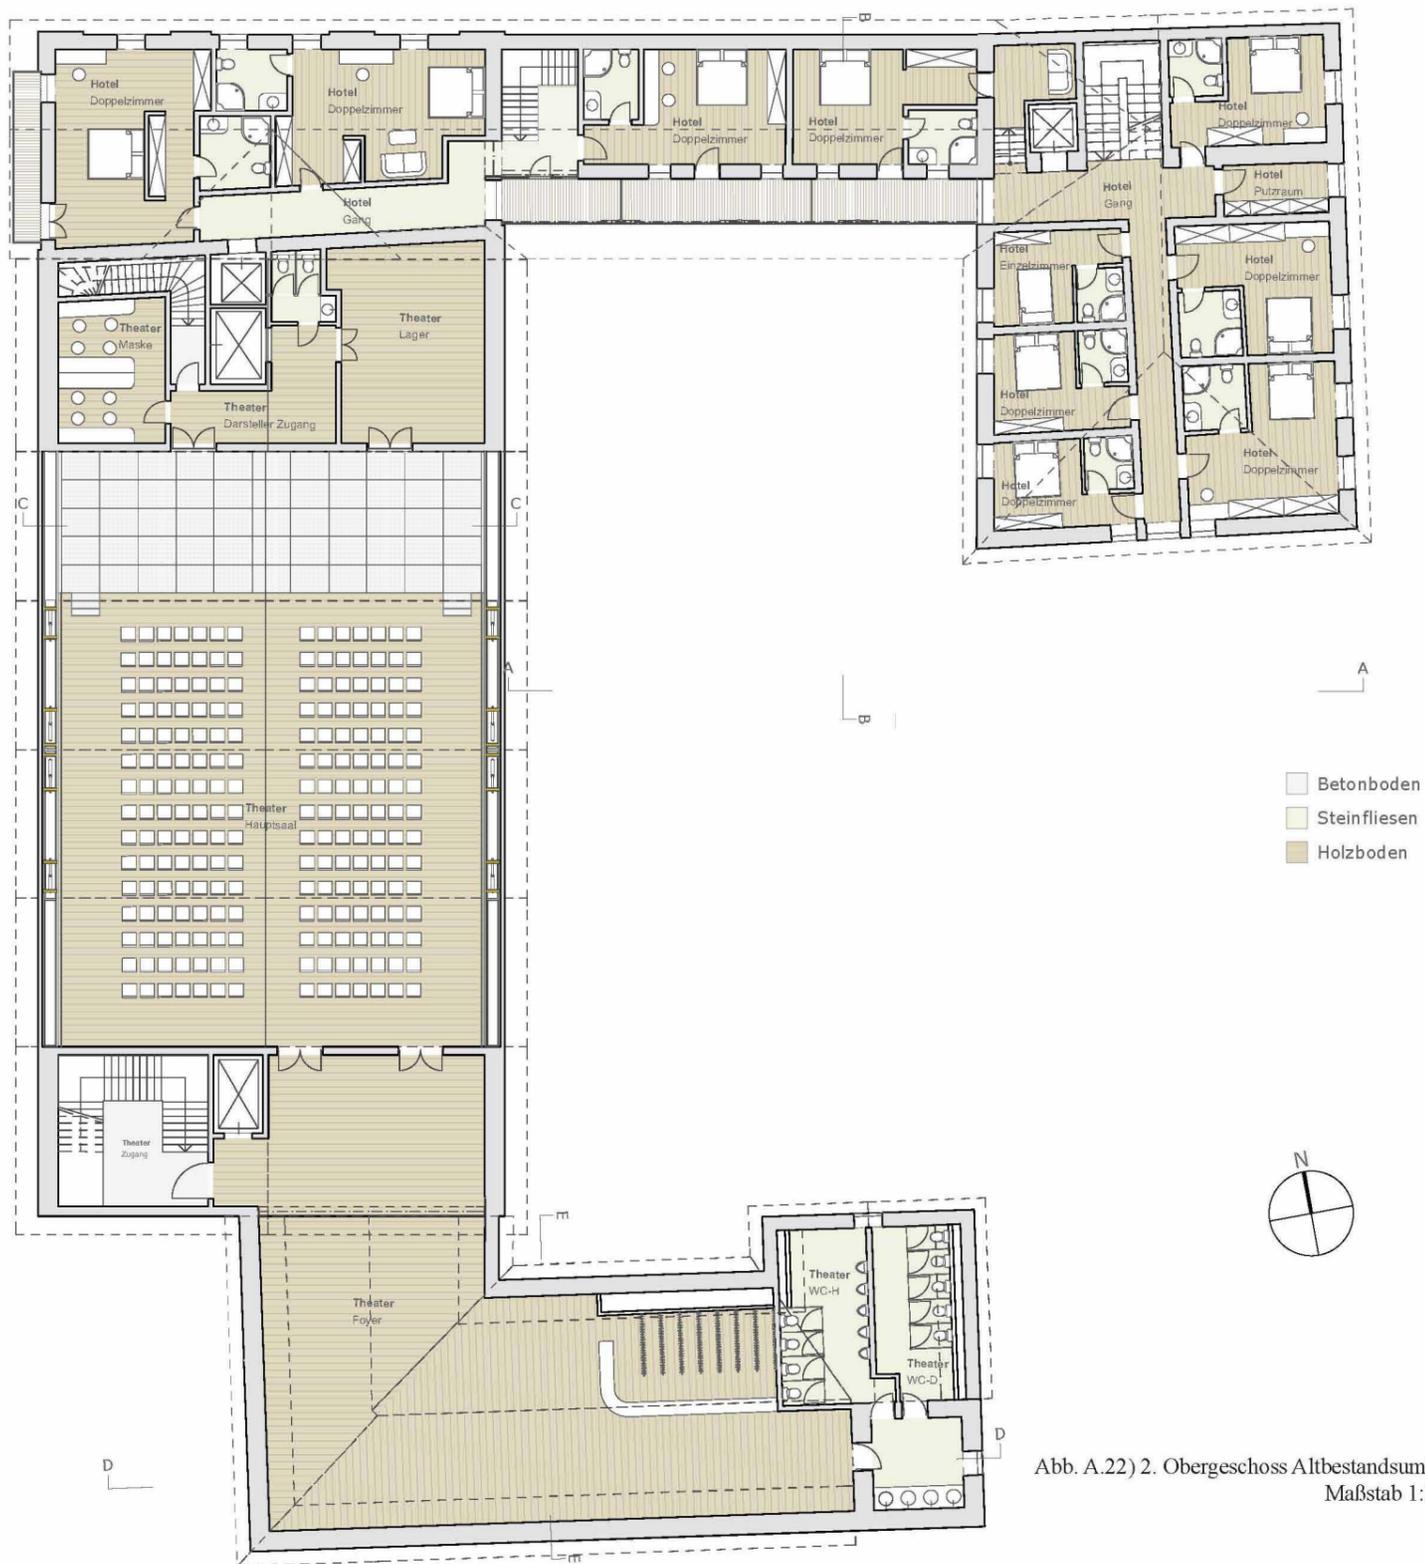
2. Obergeschoss Altbestandsumbau
